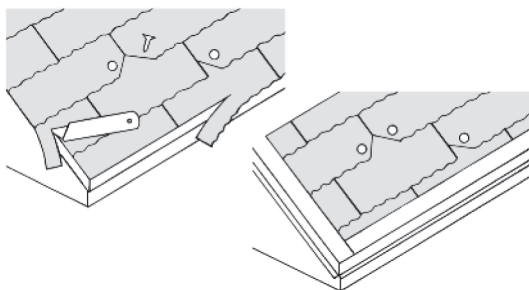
Подготовка старой кровли к укладке нового гонта.
